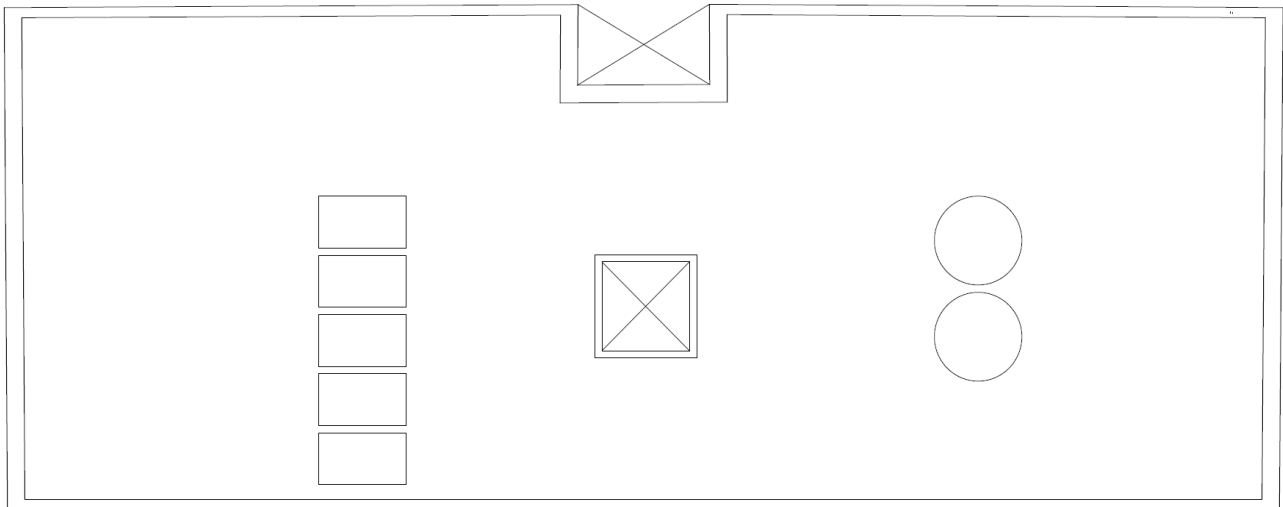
Plano Distribución Cubierta Sin Pavimento.
